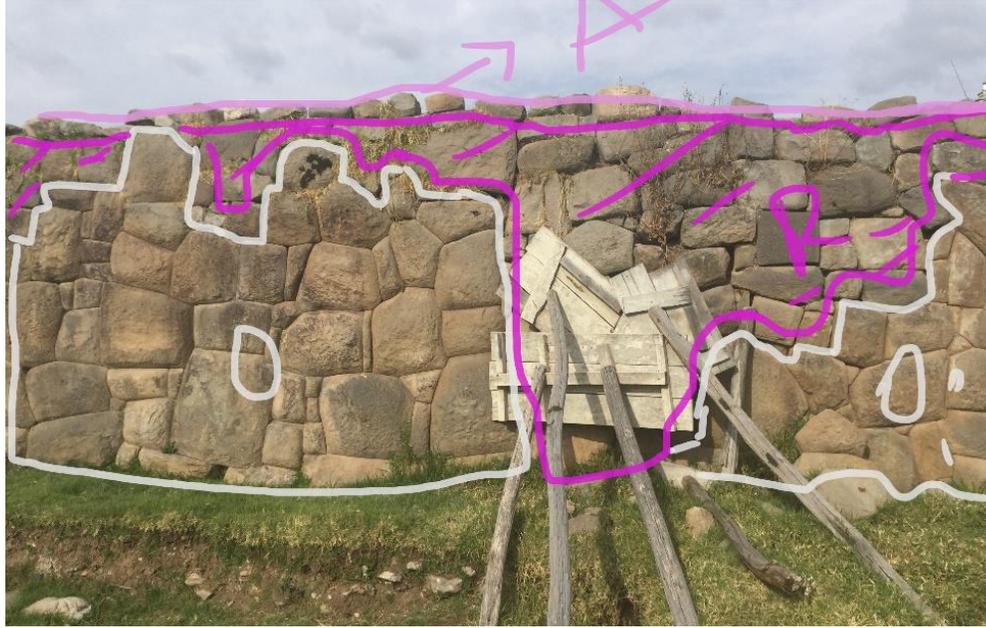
Relevamiento en campo de unidades originales y reconstruidas
